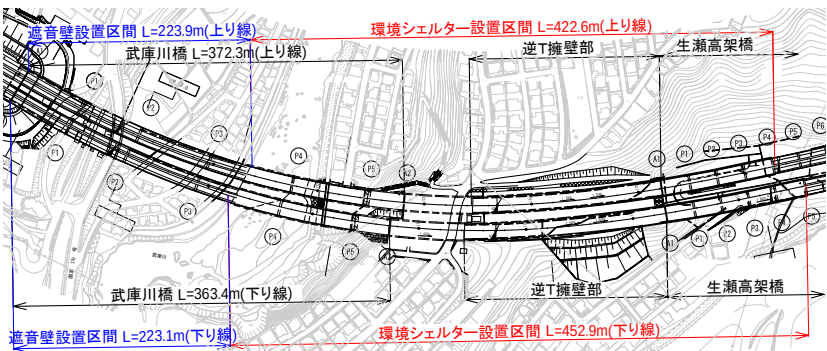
工事平面図(武庫川橋～生瀬高架橋区間)
